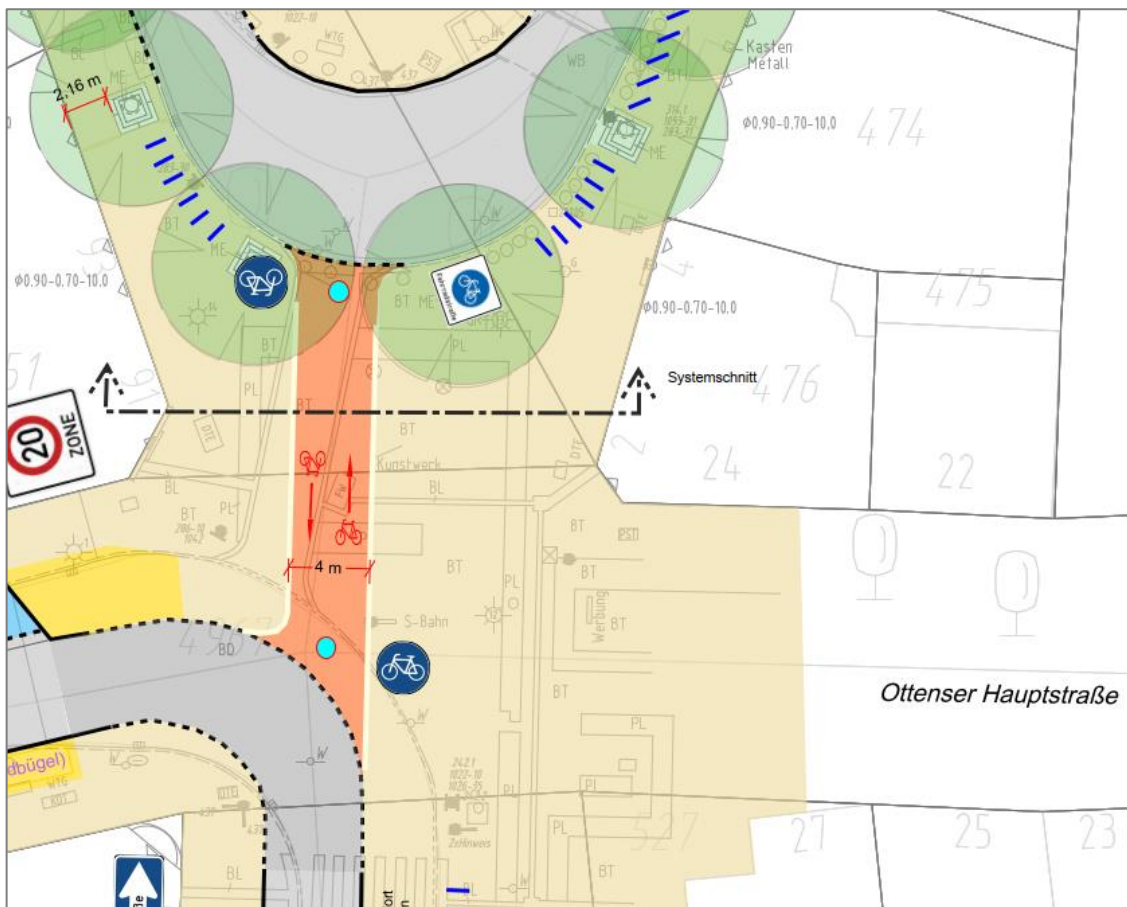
Abschnitt 2, Variante 1 „angepasster Bestand“, Lageplan
